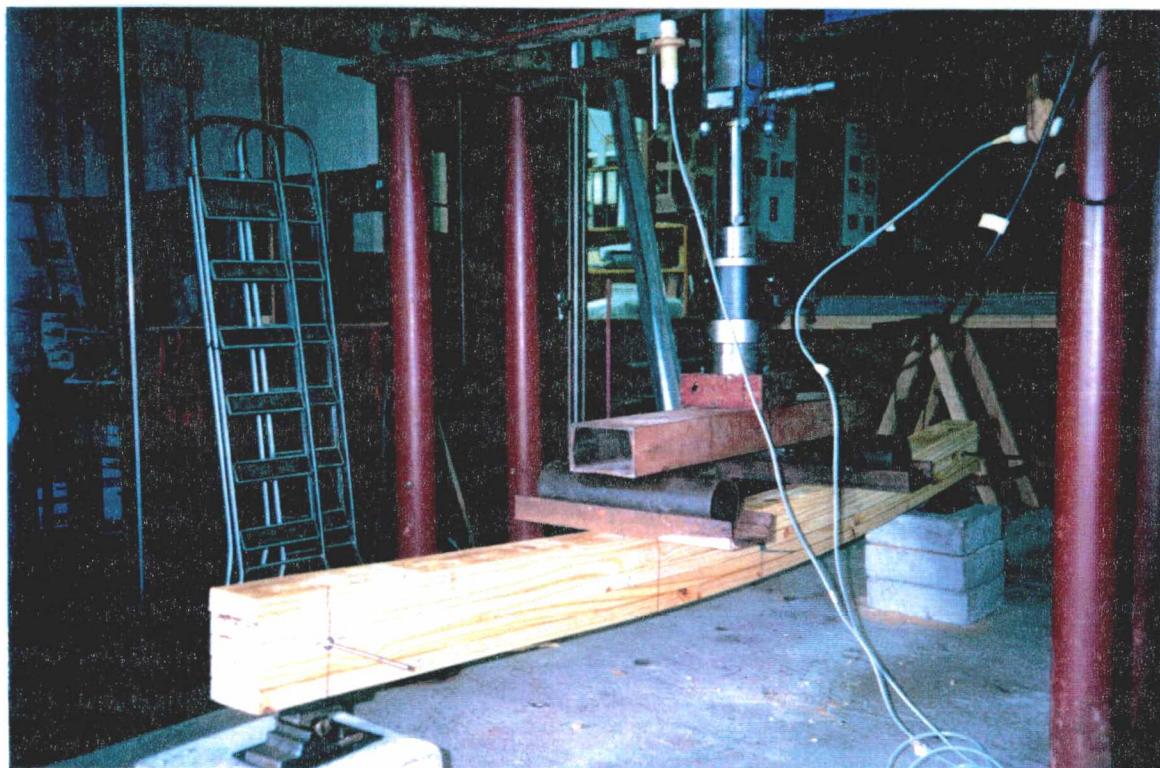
Ilustração do ensaio de flexão a 4 pontos, das vigas
